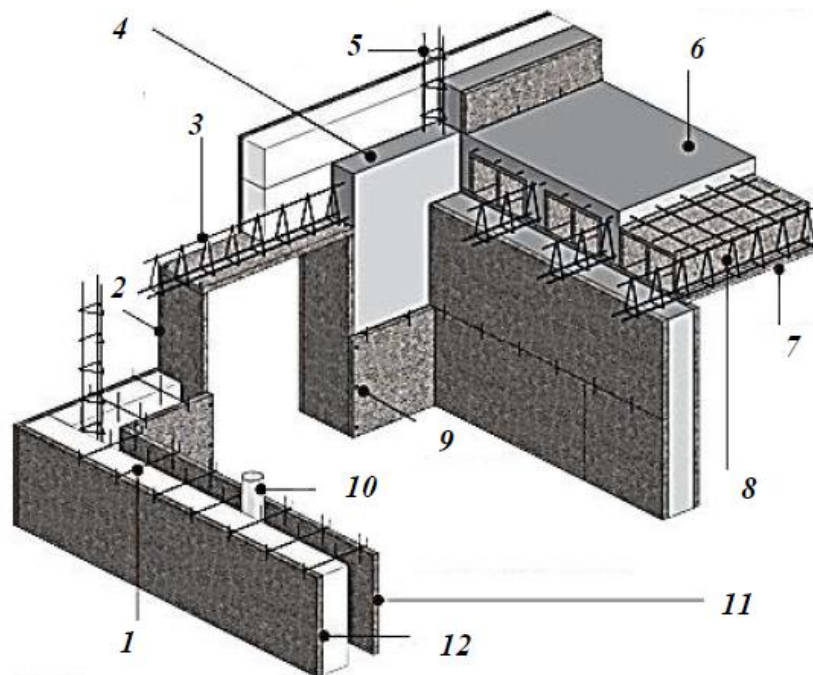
Конструктивна схема опалубки ДСП на цементній зв'язці: 1 - металеві підкладки; 2 - торці отвору з одношарової плити; 3 - підсилення перемички; 4 - бетон; 5 - вертикальна арматура; 6 - збірно-монолітне ребристе перекриття; 7 - блоки опалубки перекриття; 8 - арматура перекриття; 9 - кріплення до кілків; 10 - комунікаційні труби; 11 - внутрішня обшивка панелей; 12 - зовнішнє покриття панелей шаром пінопласту
